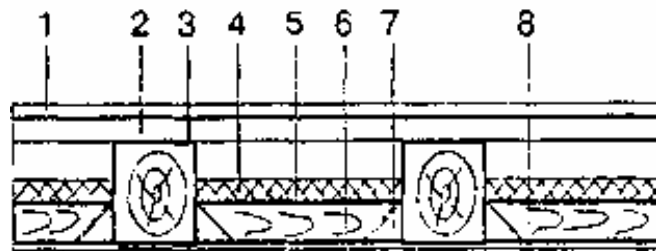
Утеплювач міжповерхового дерев'яного перекриття
